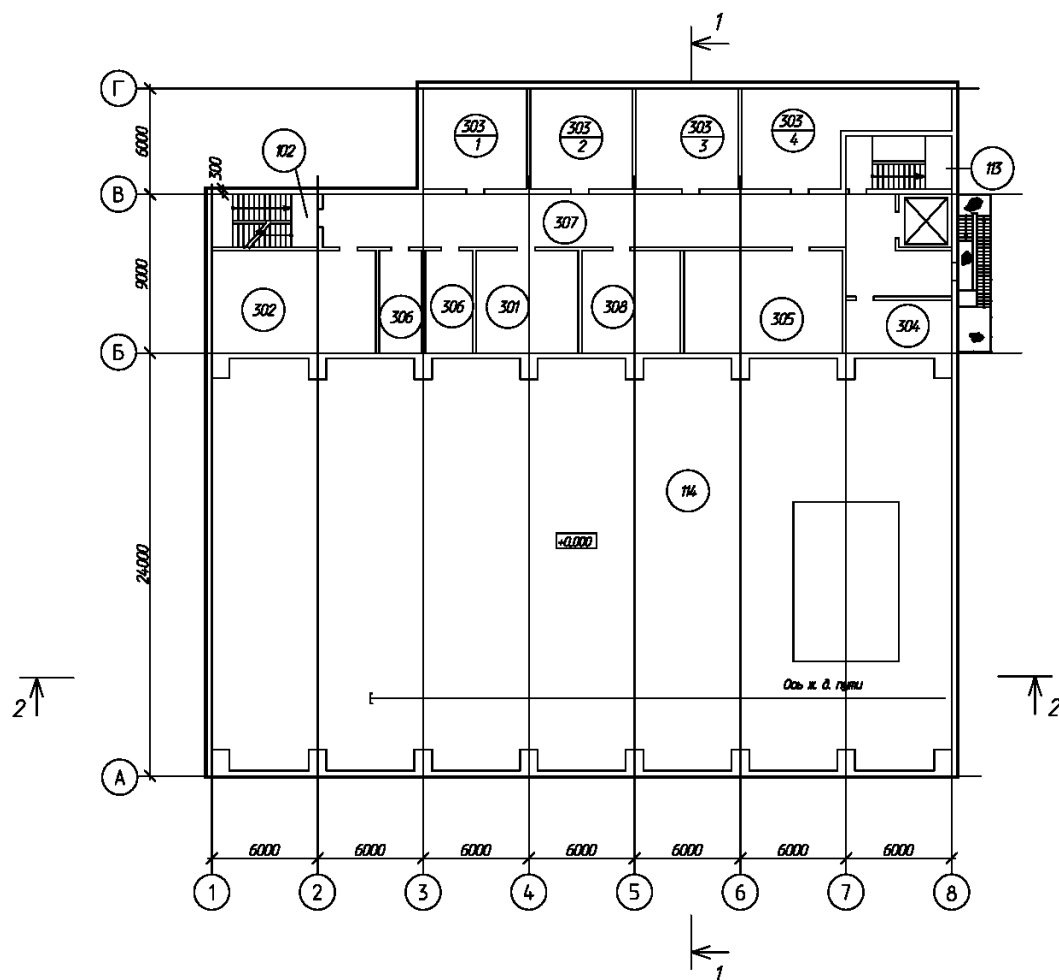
Здание приемки. План на отметке 7,800
